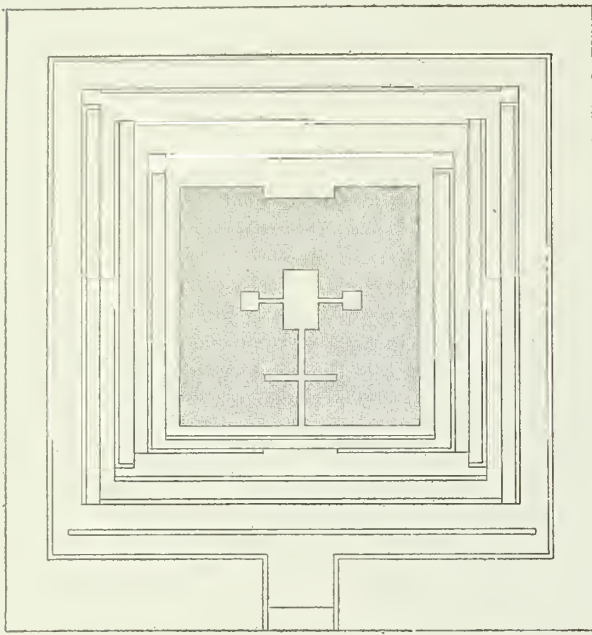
TEMPLO CALDEO-ASIRIO DE PLANTA CUADRADA Y RAMPA DOBLE: PLANTA (RECONSTITUCIÓN DE CHIPIEZ)
